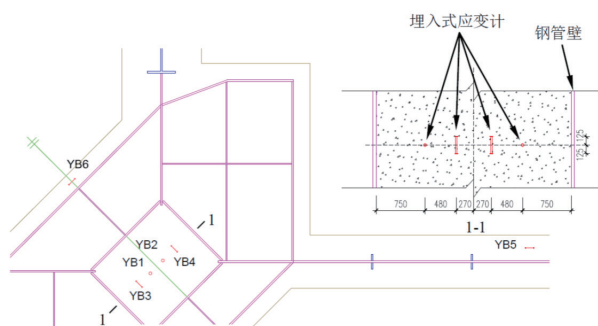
混凝土收缩应变计布置图(尺寸单位: mm)
